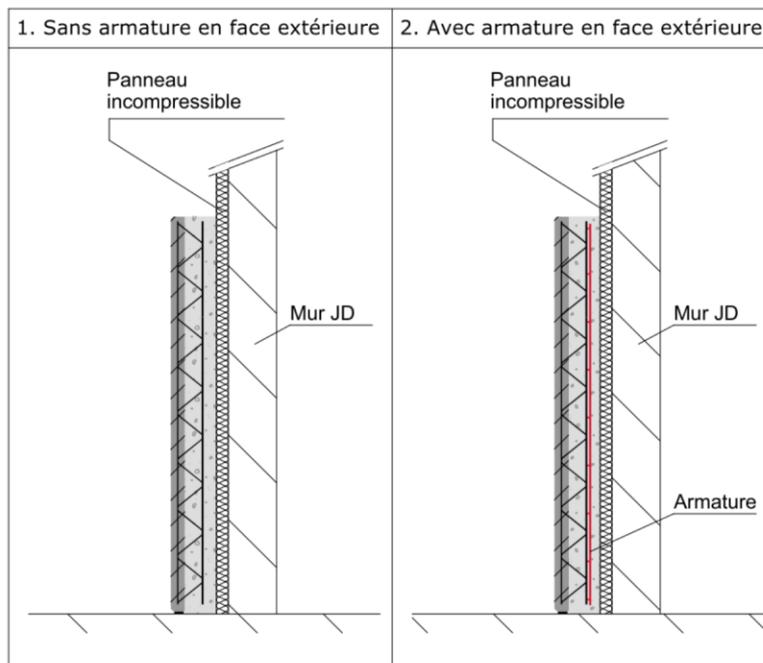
Mur de joint de dilatation avec ou sans ferrailage en deuxième face
